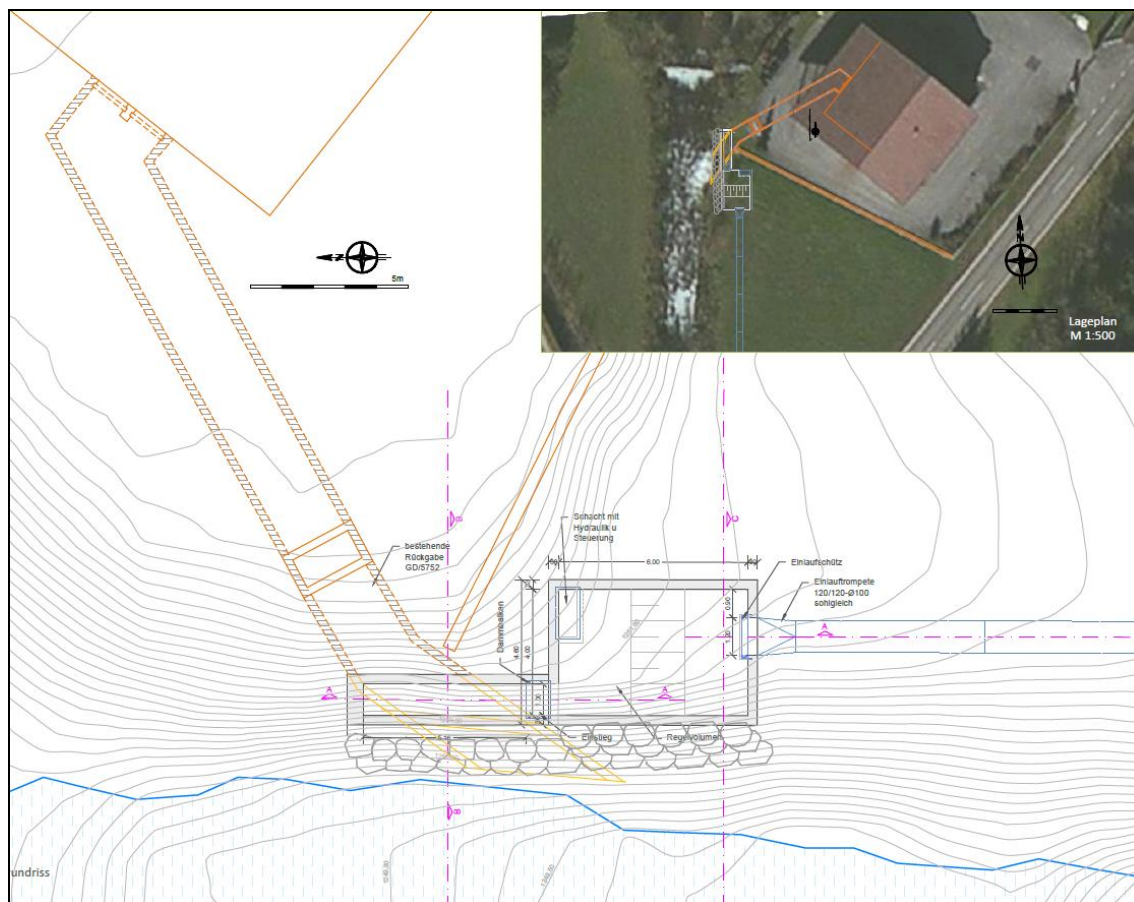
Sezione dell'opera di presa di progetto (fonte: Tavole progettuali)
